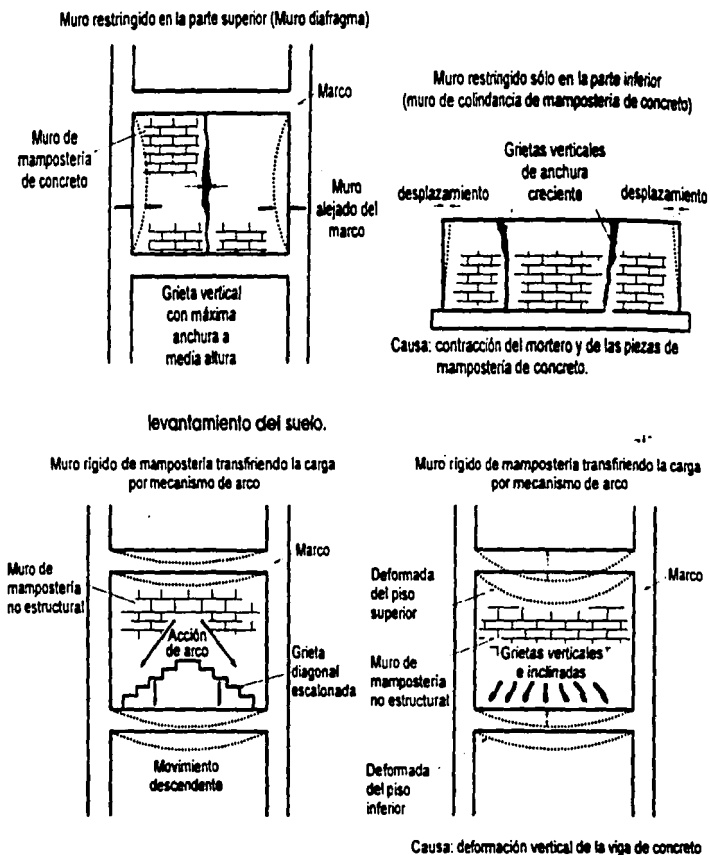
Tipos de grietas en muros de mampostería
